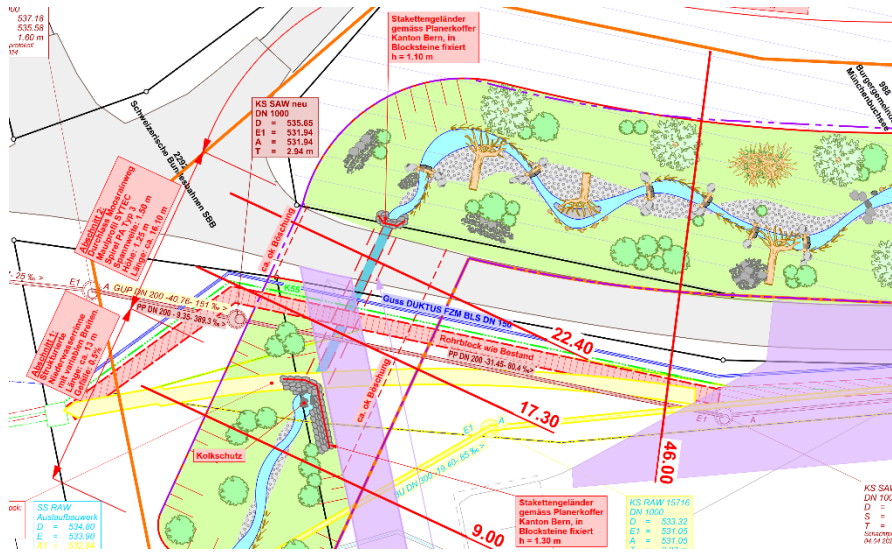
Ausschnitt Situationsplan Stand Wasserbauplan, 26.07.2024
